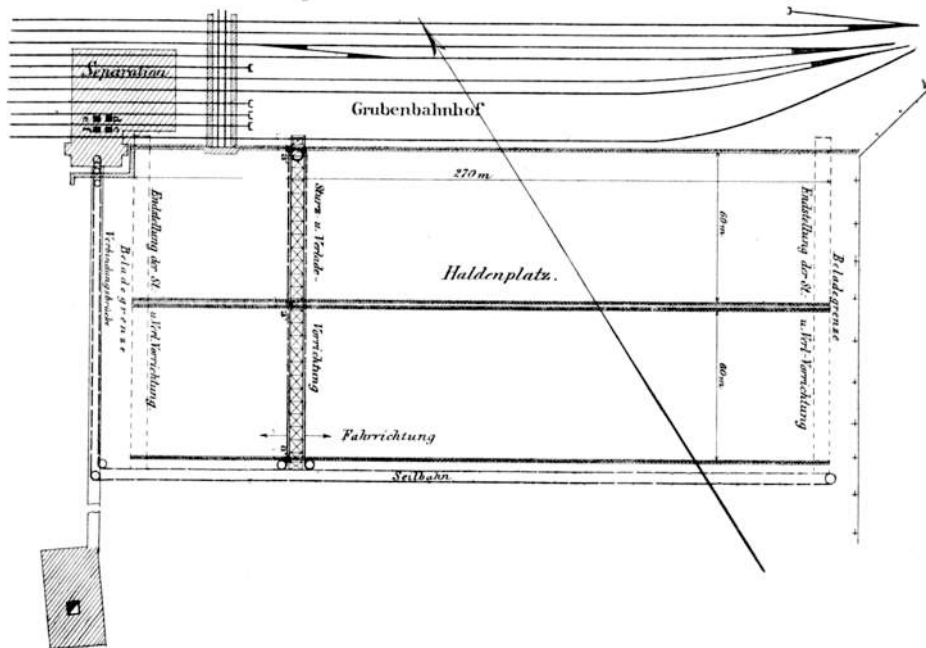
Sturz- und Verladeeinrichtung auf dem Hillebrandschacht der Gottessegengrube. Grundriß.
